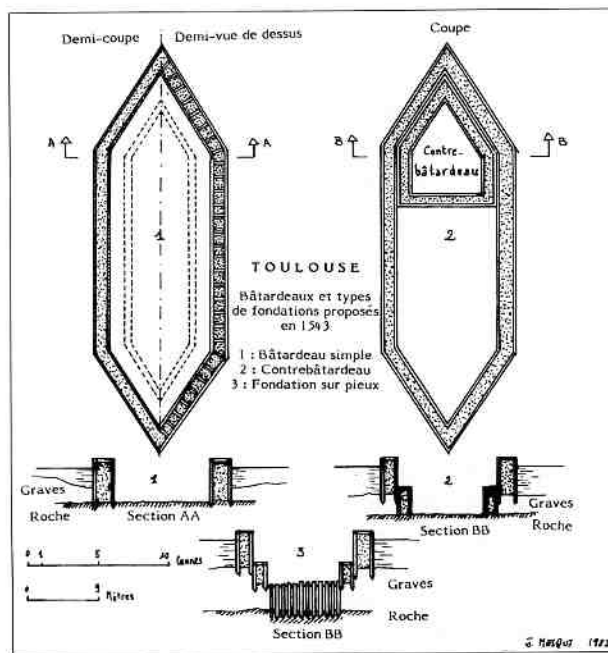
Plans de deux batardeaux proposés en 1543 pour la fondation des piles.
